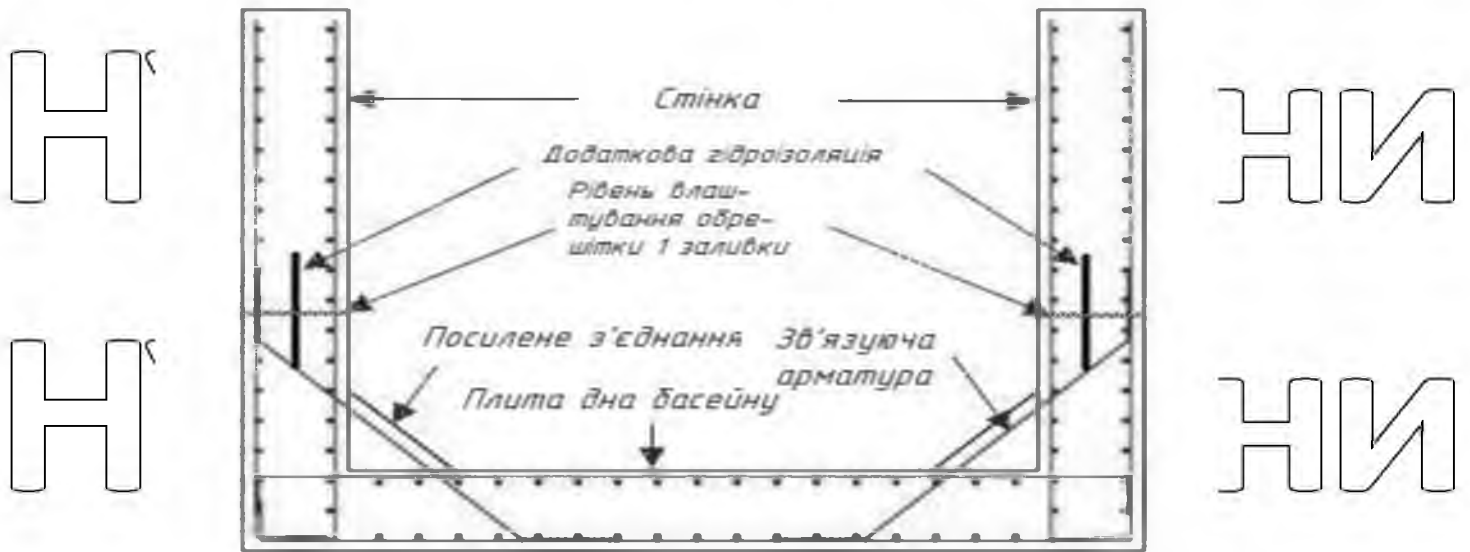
Варіант влаштування арматури за посиленого з'єднання стінок басейну з плитою
